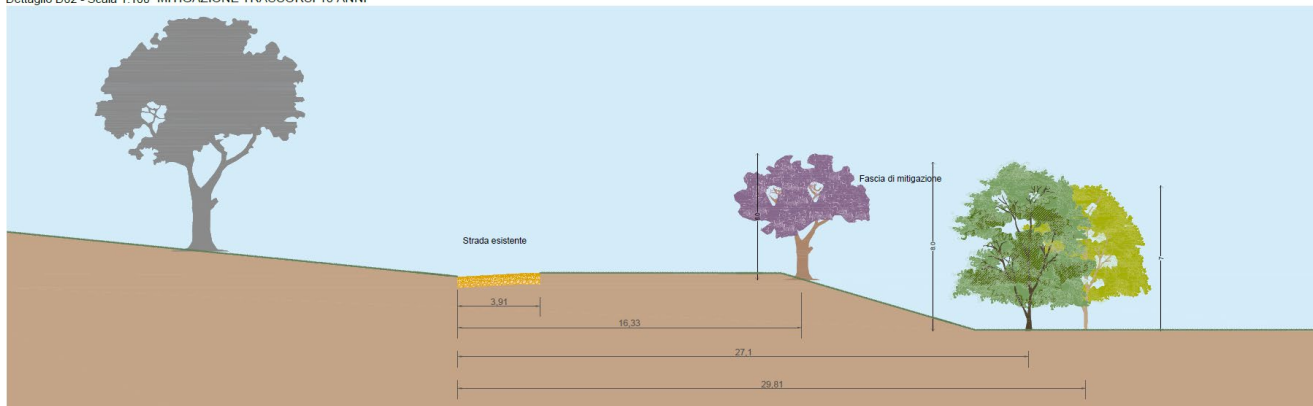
Sezione della fascia di mitigazione all'impianto e a maturità
